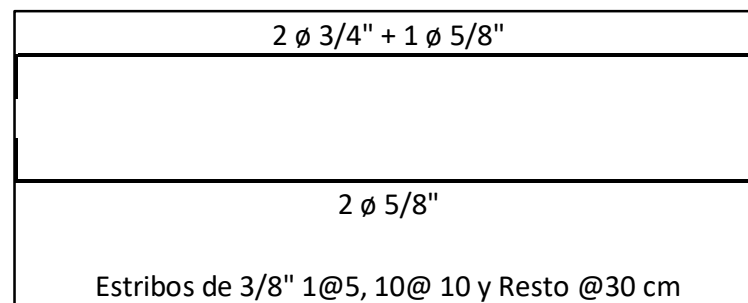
Detalle del refuerzo de la viga principal V-35x70
